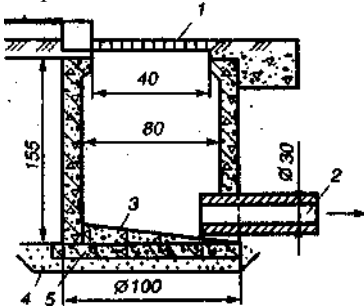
Схема устройства железобетонного дождеприемника: 1-приемная решетка; 2 – соединительная ветка; 3 – лоток с набивкой; 4 – песчаная подушка; 5 – основание (размеры даны в сантиметрах)
